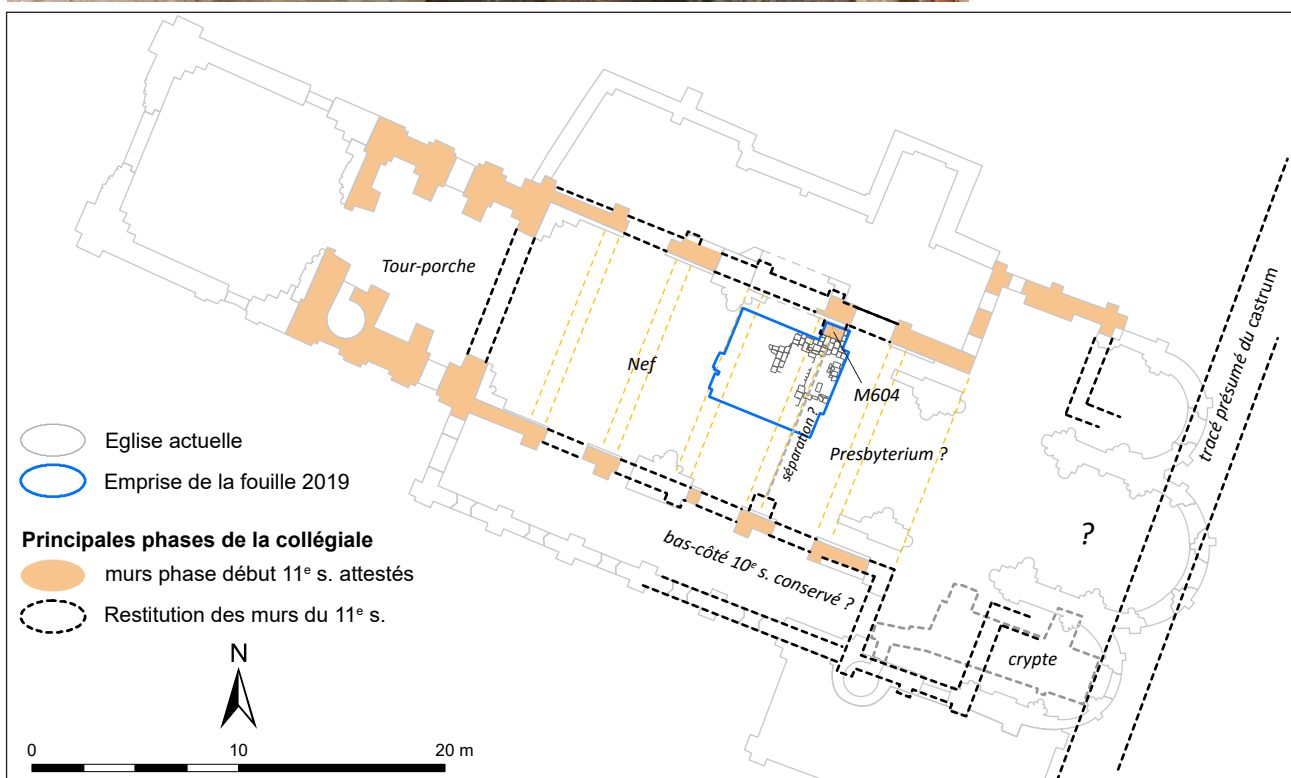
Plan restitué de la collégiale du début du 11^e s.
